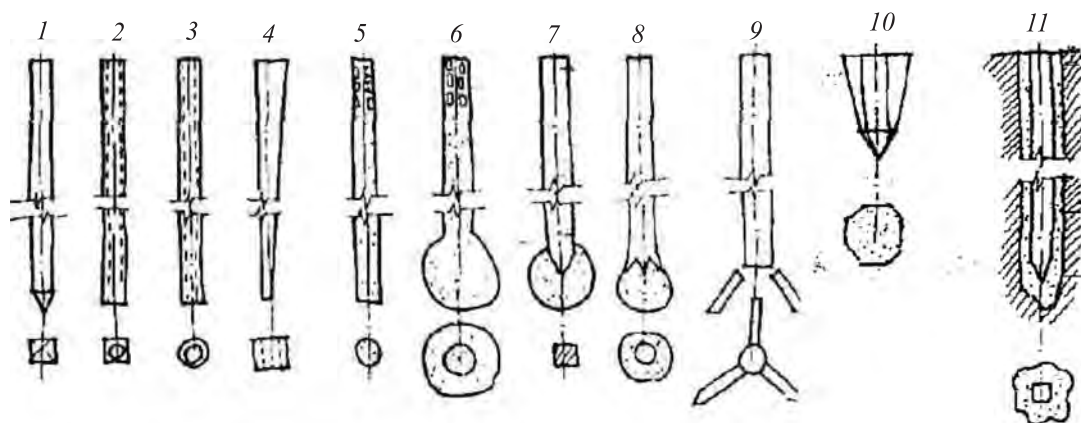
Виды свай: 1, 2, 3, 4 — бетонные и железобетонные сваи квадратные, круглые, сплошные, пустотелые; 5, 6 — набивные обычные и с уширенной пятой; 7, 8 — камуфлетные; 9 — с шарнирно раскрывающиеся упорами; 10 — призматические; 11 — свая в лидерной скважине
